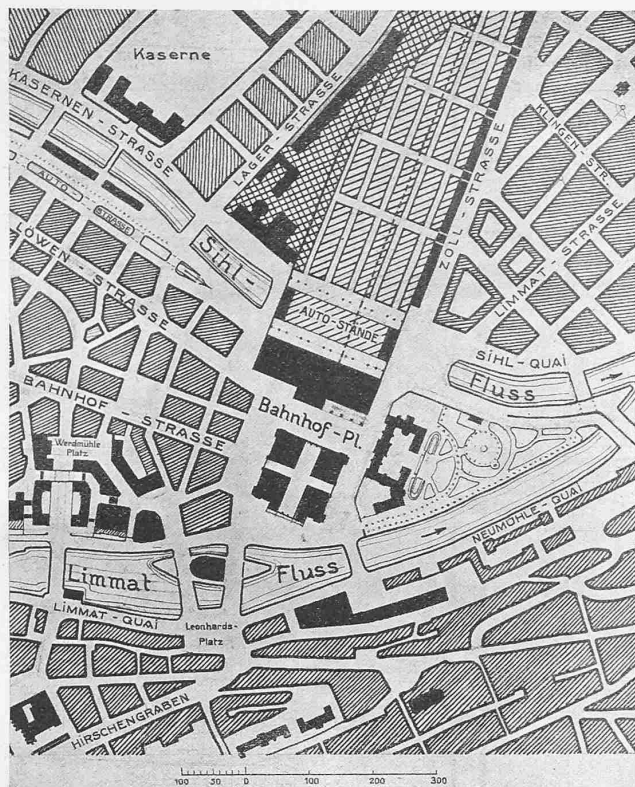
Projekt Prof. Gull 1928 für einen hochliegenden Kopfbahnhof Zürich. Grundriss in Strassenhöhe, mit vermietbaren Lagerräumen unter den Bahngeleisen. — Masstab rund 1:10000.
